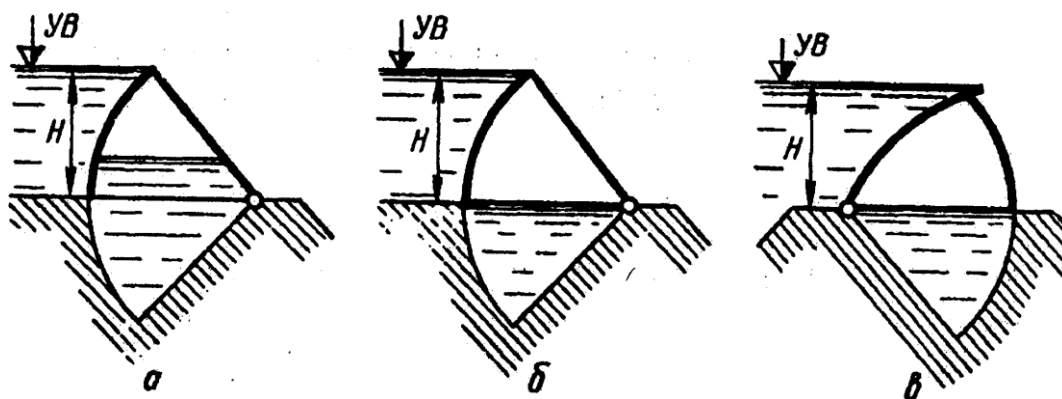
Типы секторных затворов: а - тонущие с осью вращения на низовой стороне; б - поплавковый с осью вращения на низовой стороне; в - поплавковый с осью вращения на верховой стороне.
